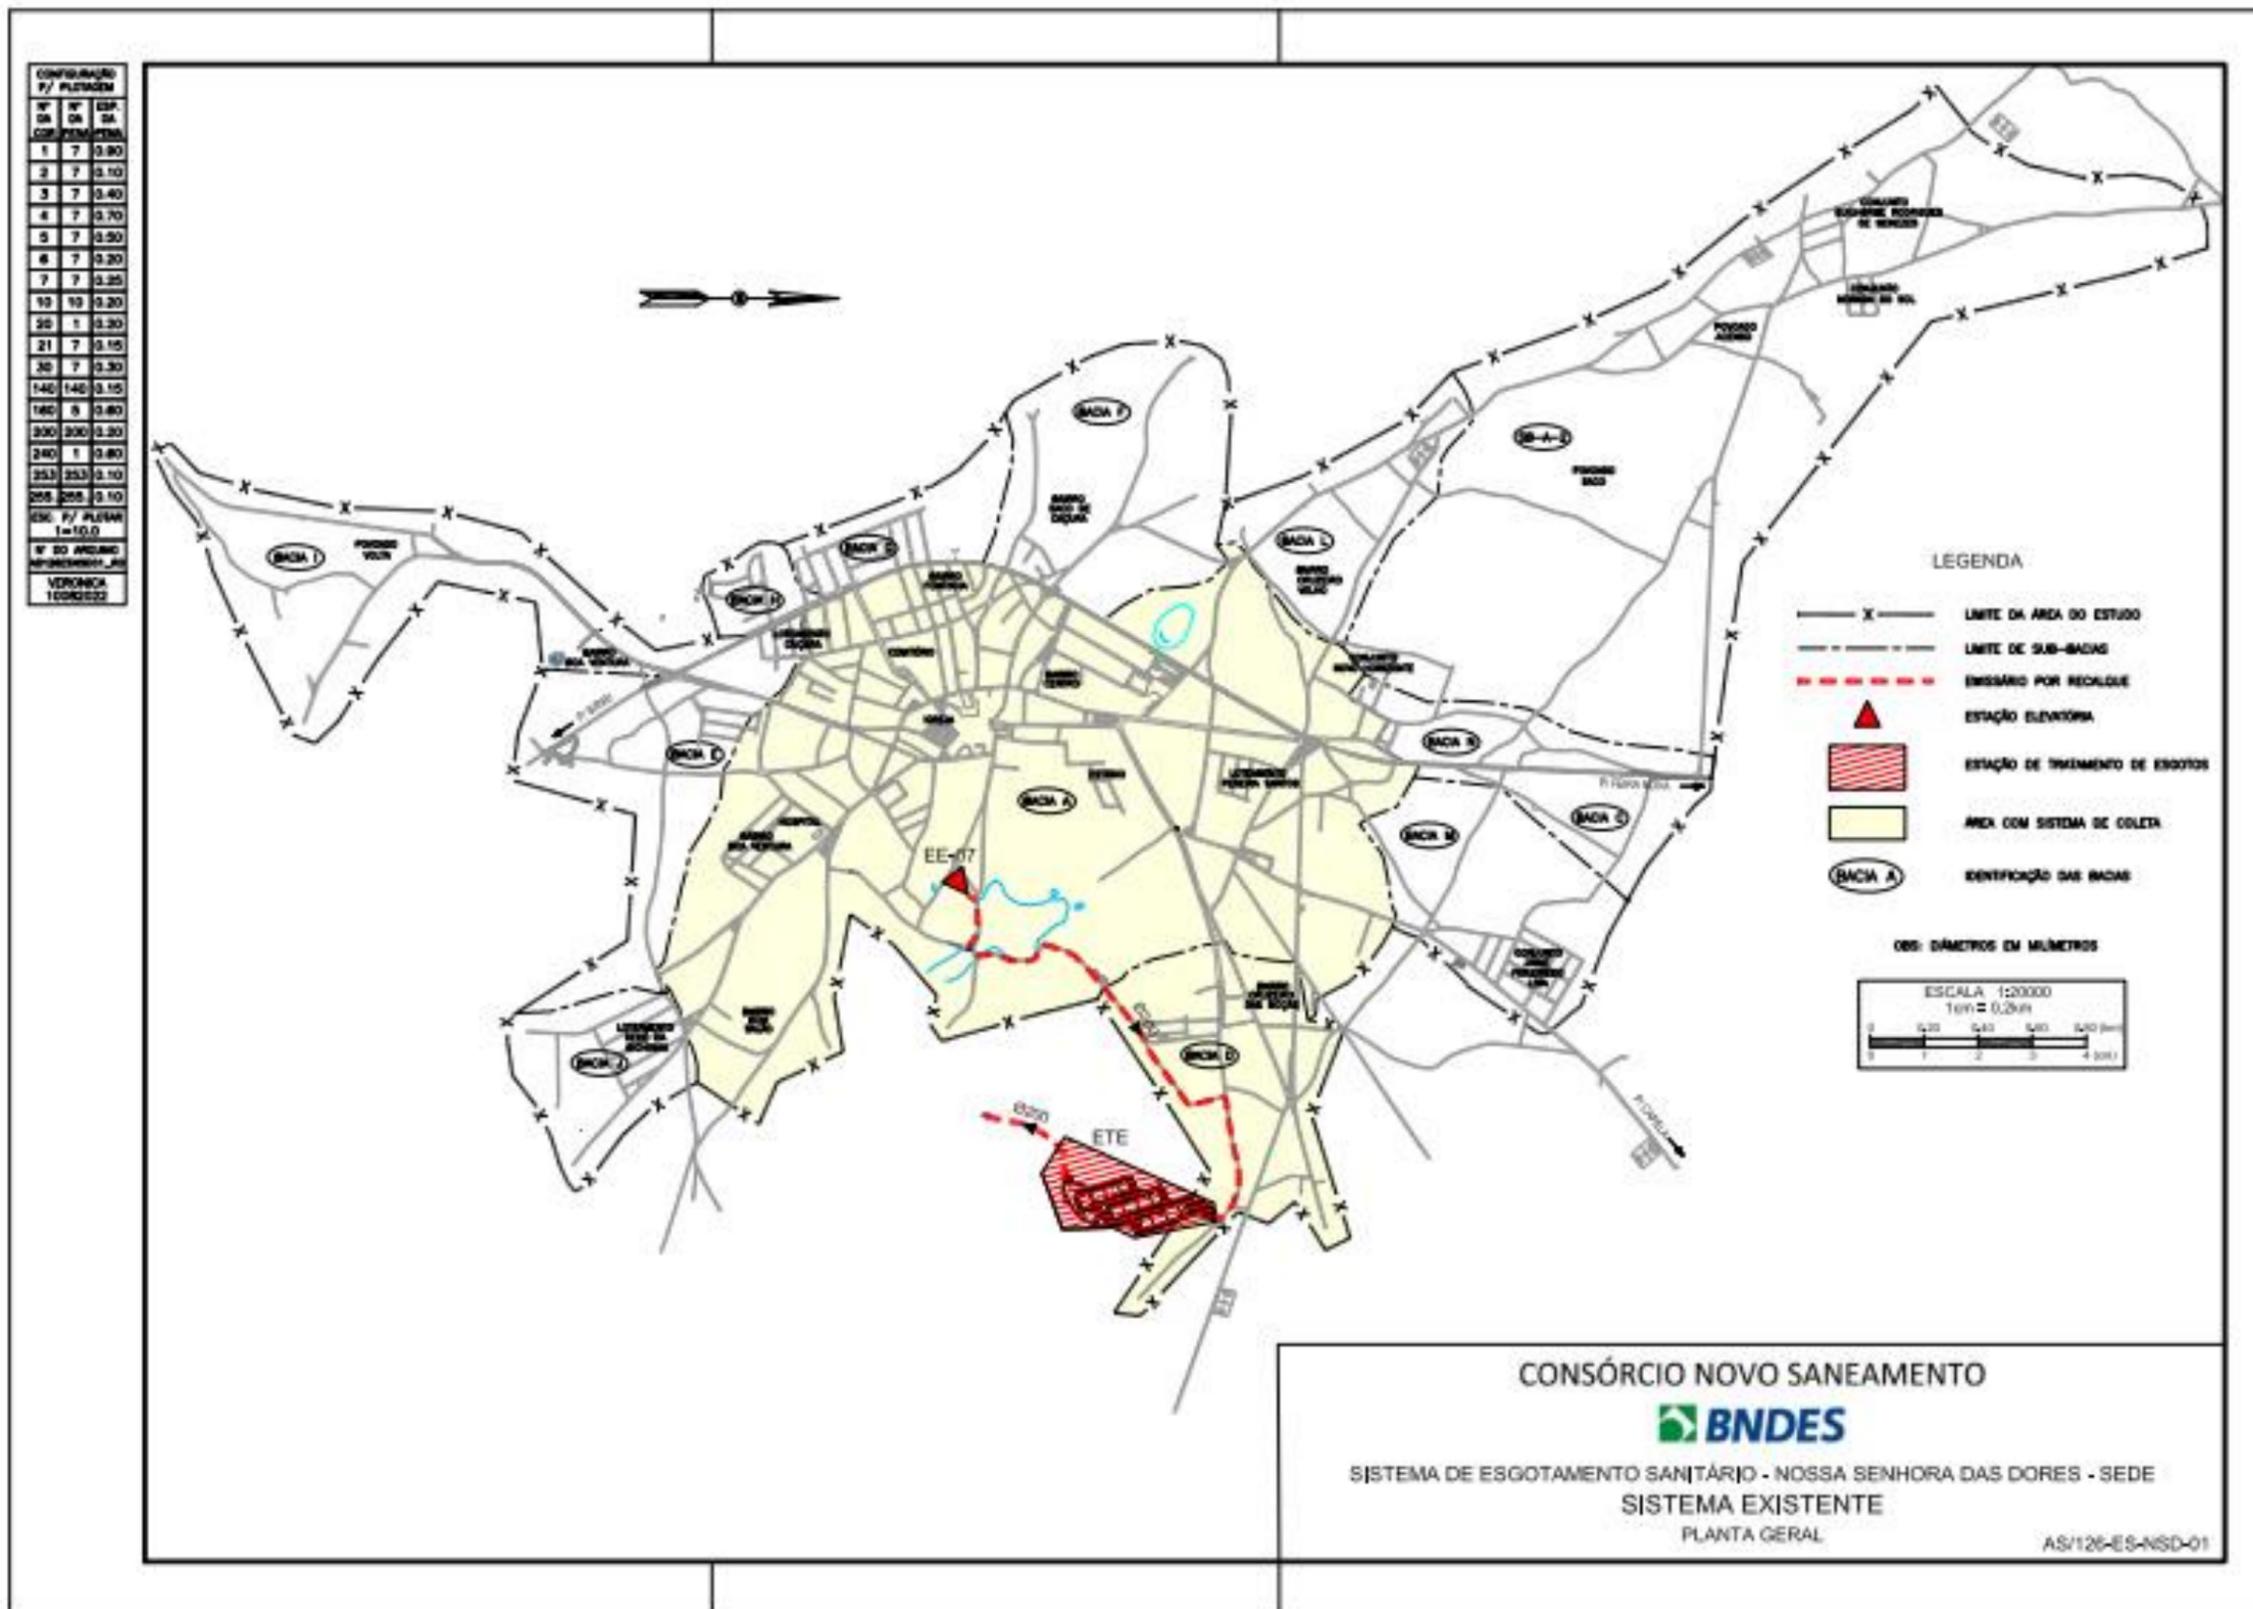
Planta do Sistema de Esgotamento Sanitário – NOSSA SENHORA DAS DORES
